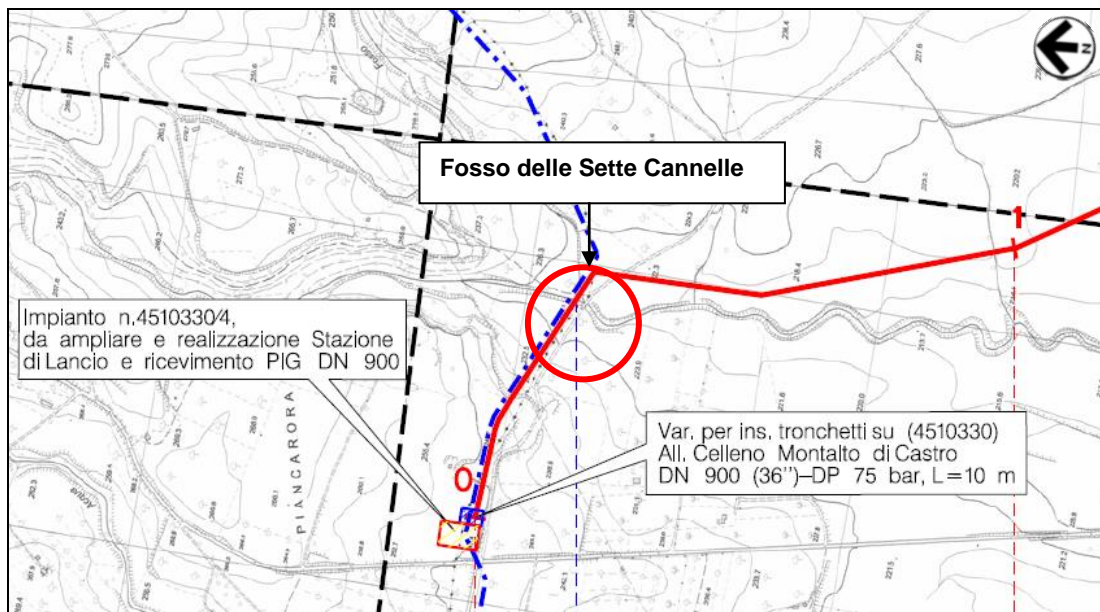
/B – Stralcio planimetrico con localizzazione dell'attraversamento (progr. Km 0+347)
